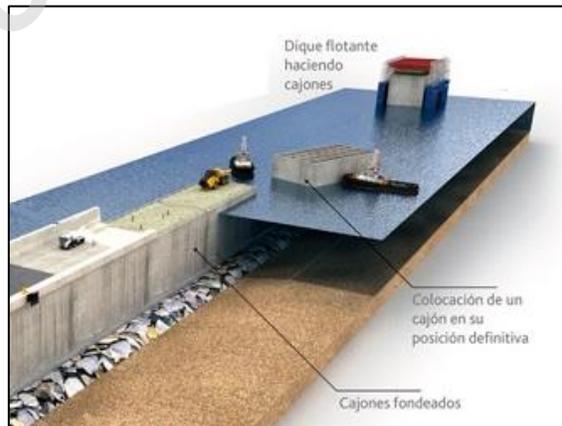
Construcción de Cajones Celular de Hormigón Armado.
